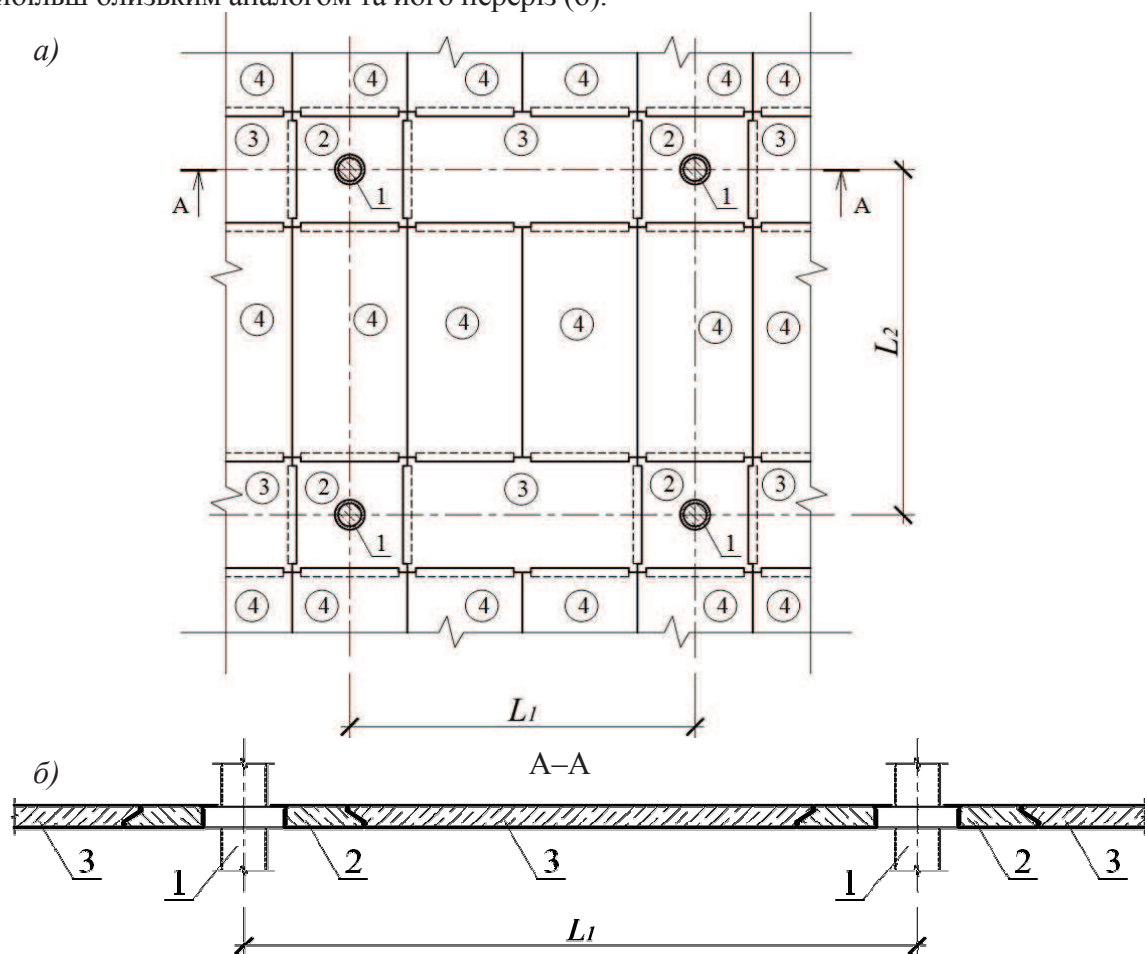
Схема збірному залізобетонному безбалковому перекриття
